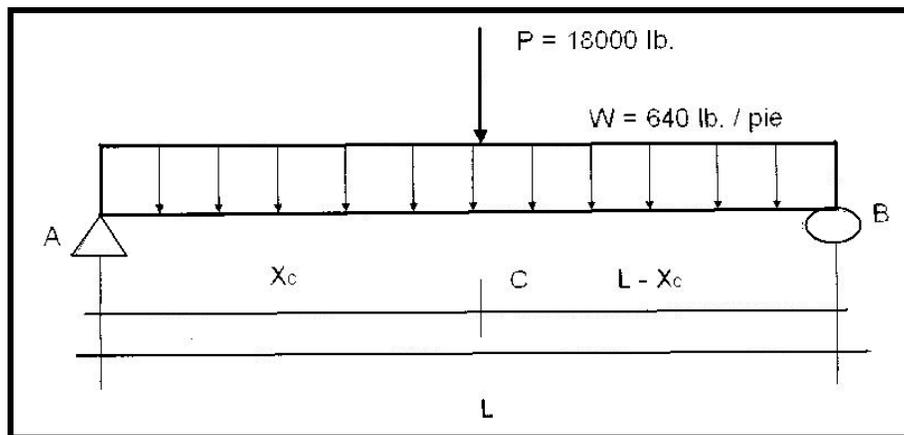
Modelo de carga para carril de carga (Para las cargas carril HS 20)
